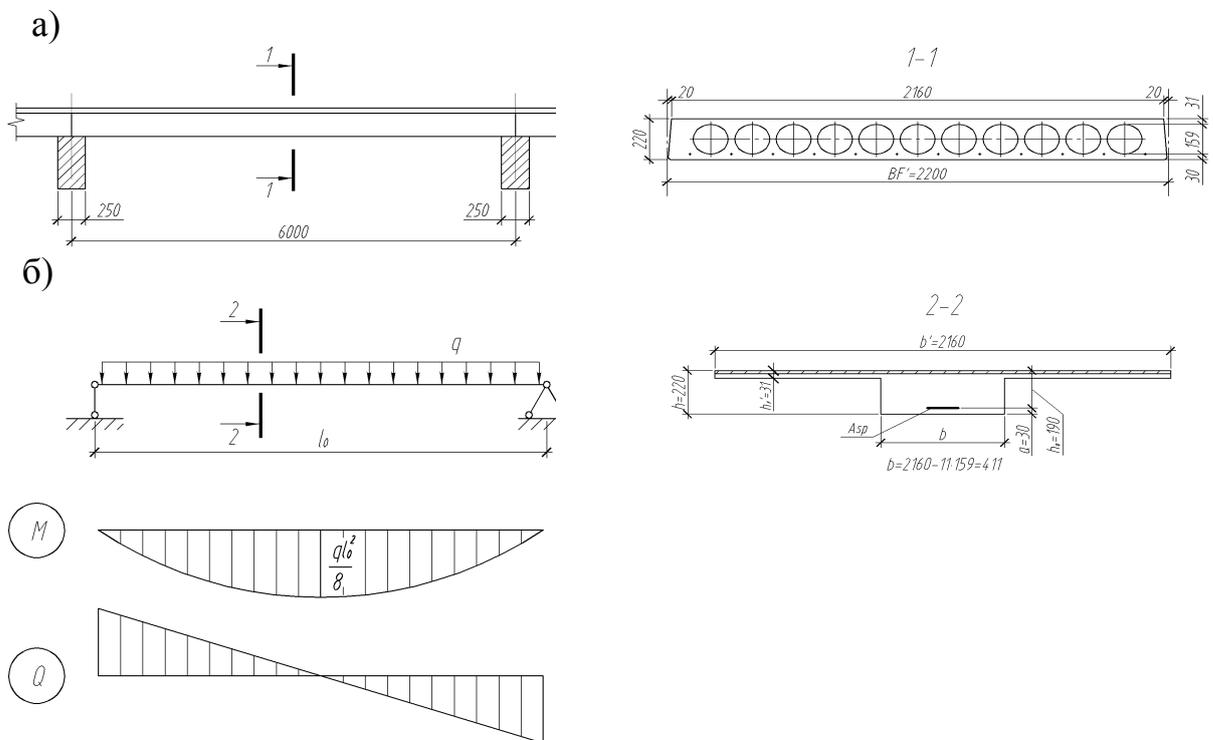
Геометрические размеры (а) и расчётная схема (б) плиты
